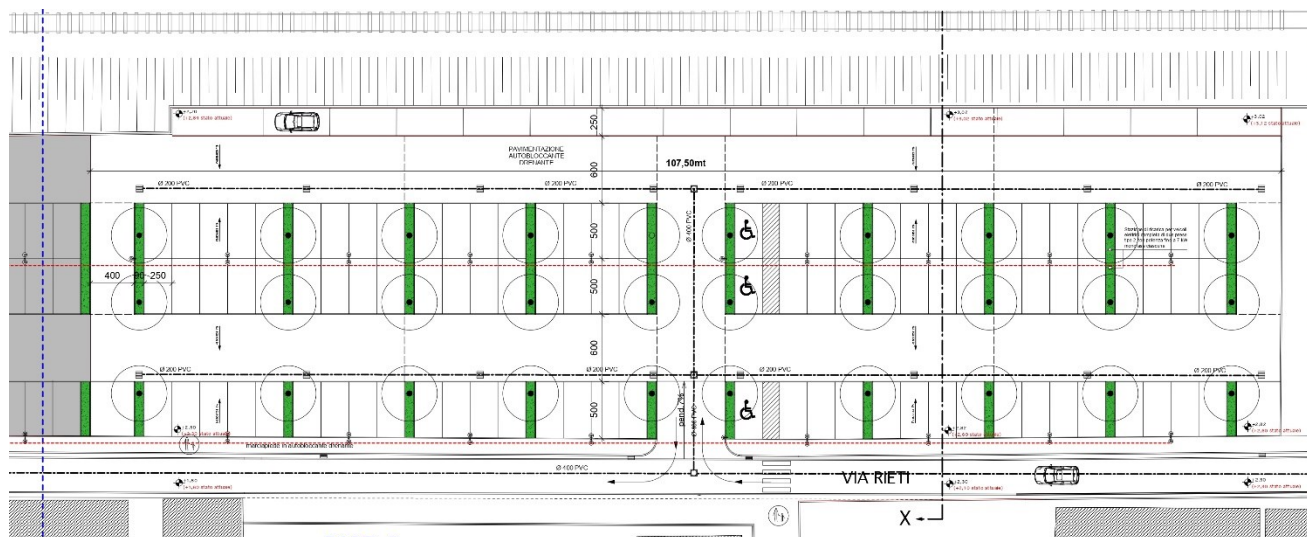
Pianta nuovo parcheggio zona B1.7
